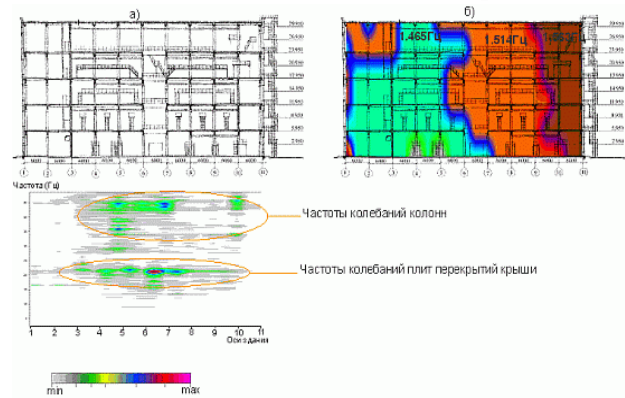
Частоти коливань плит перекриття даху будівлі і колон (а); зміна частоти першої форми поперечних коливань за поздовжнього перерізу будівлі (б)
